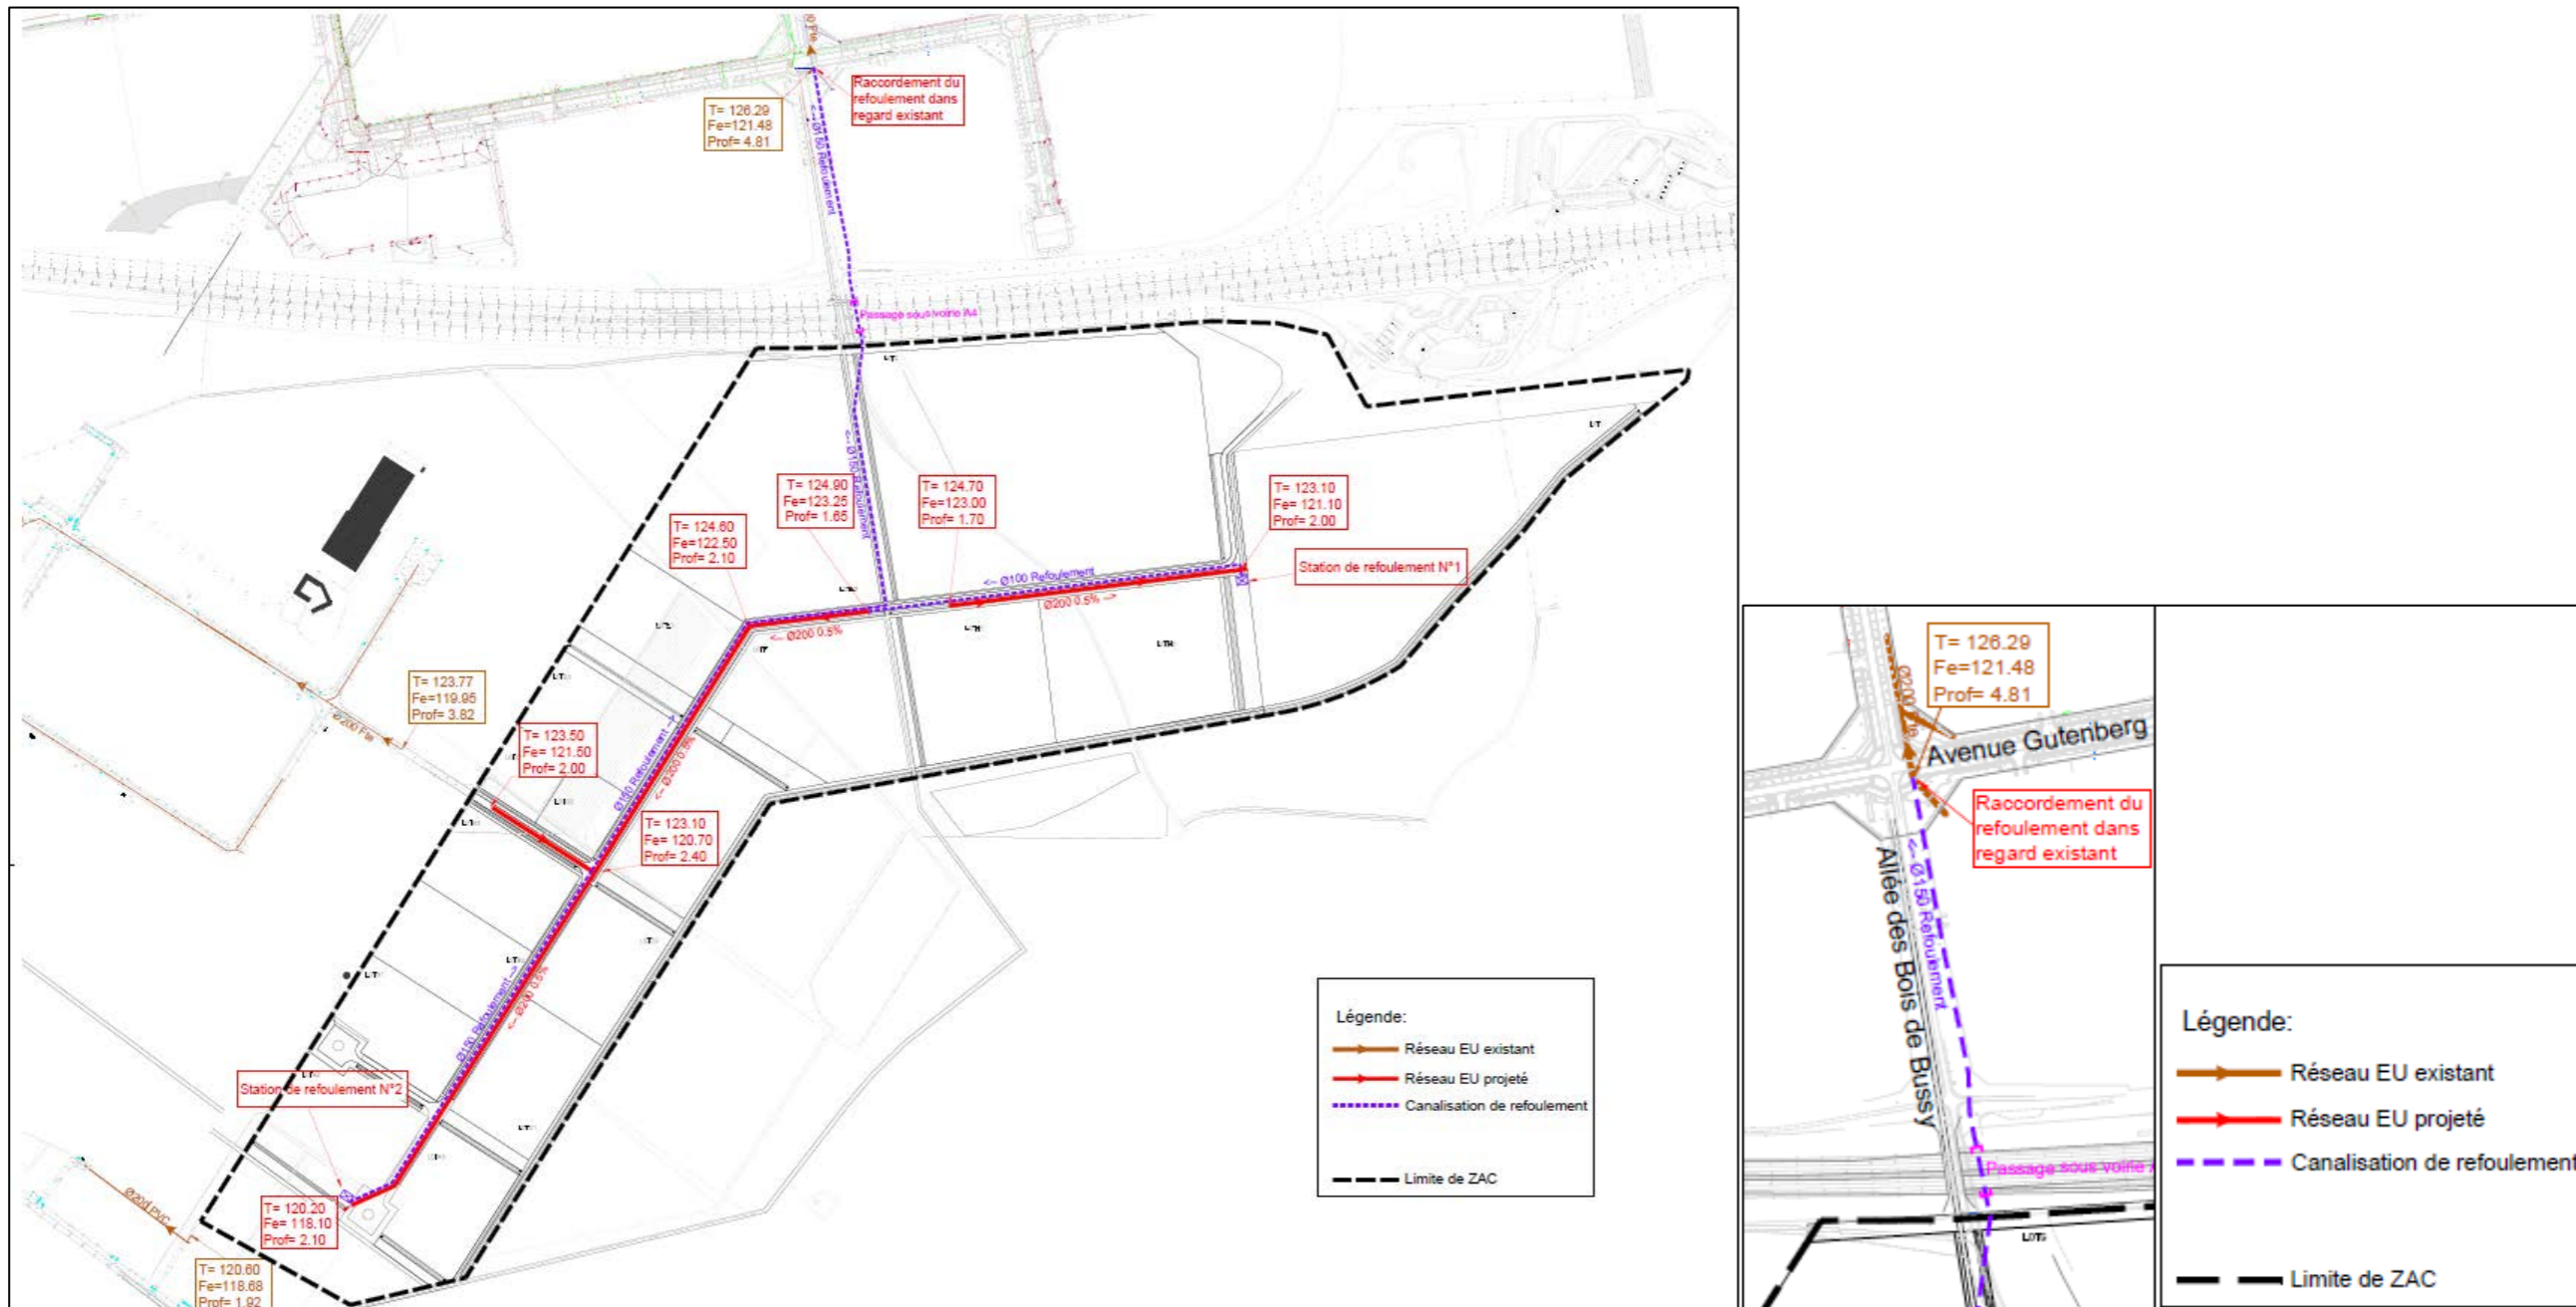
Plan du réseau eaux usées projeté et raccordement à l'existant (source : Urbatec)
